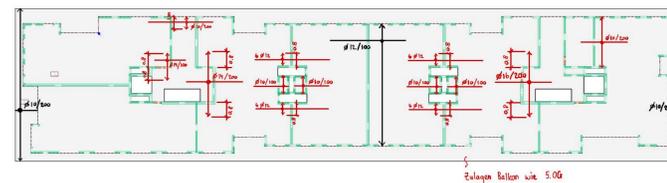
Bewehrungsplan 3. Lage Decke EG
